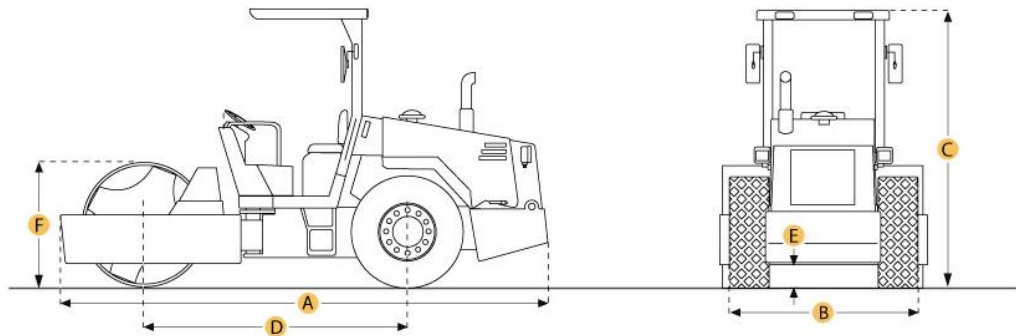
Dimensiones del rodillo liso vibratorio.
